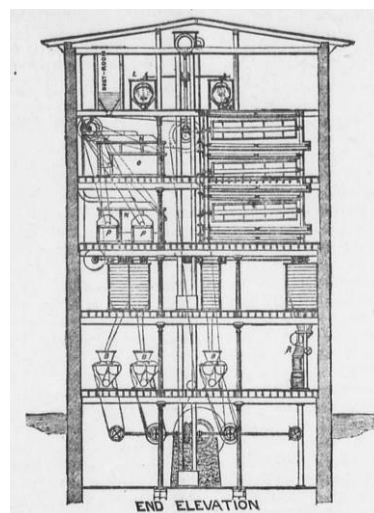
Corte de uma moagem austro-húngara⁶⁰
